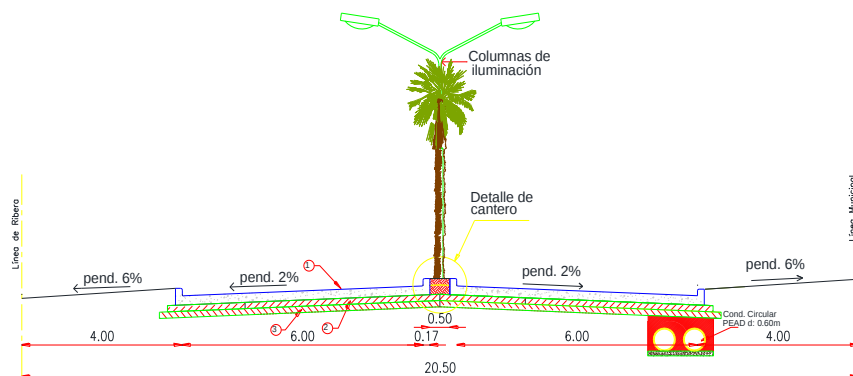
Perfil tipo calzada 12 m tipo avenida (fuente: elaboración propia).
